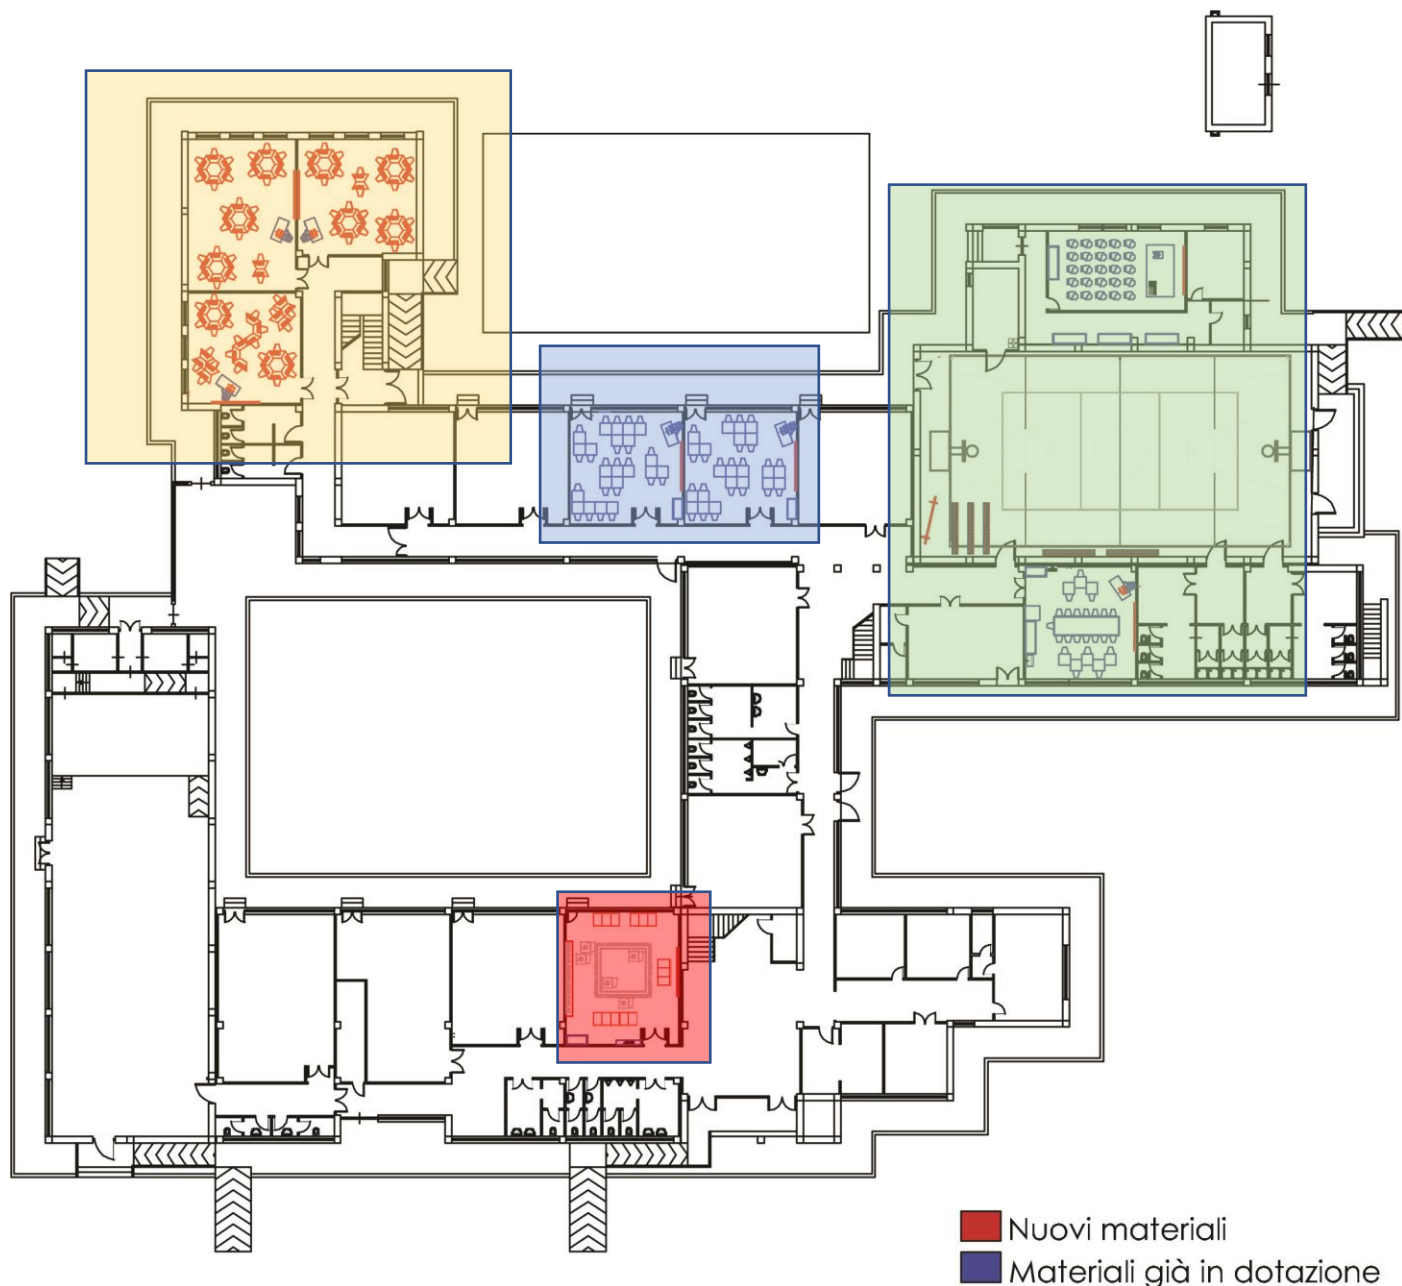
Planimetria generale_plesso di via Ponte, scuola primaria
